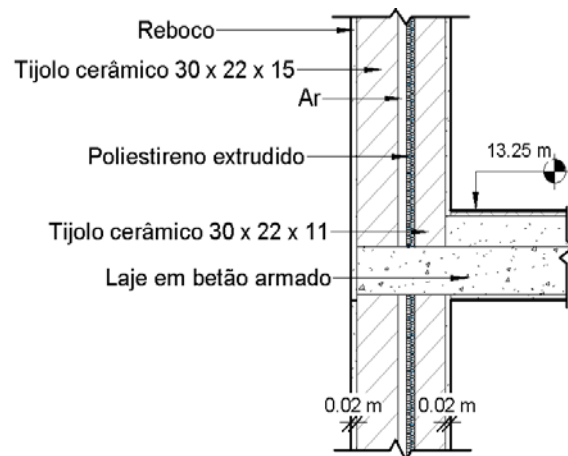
7 - Detalhe construtivo aperfeiçoado
